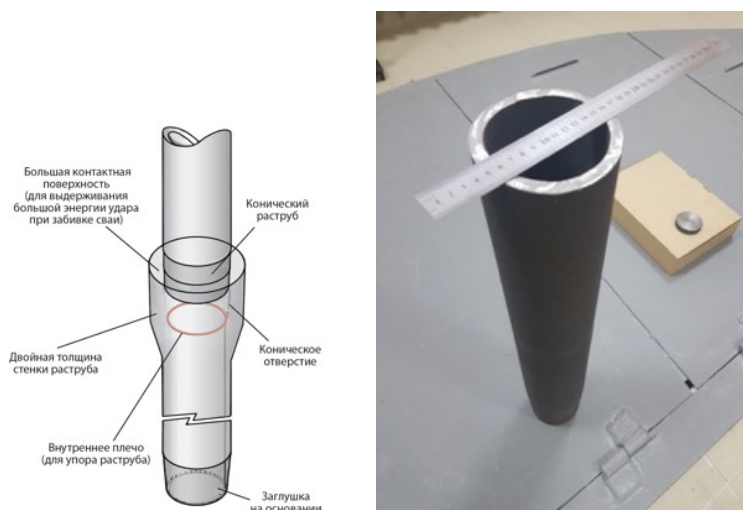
Схема сопряжения свай. Фото фрагмента ствола свай.
